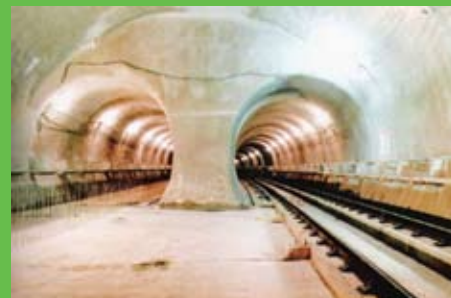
Vista do interior da Estação Jardim São Paulo durante a escavação, Metrô de São Paulo (CBT – 2006)
